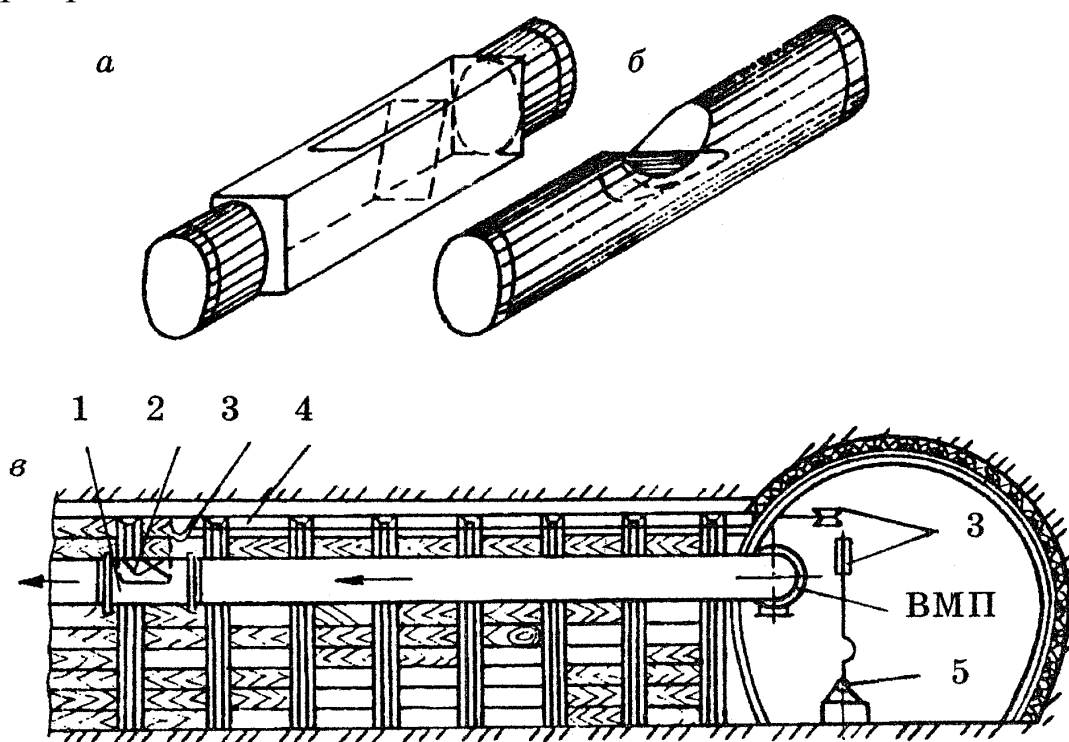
Устройство для разгазирования: а, б – схемы устройства; в – схема установки; 1 – патрубок; 2 – клапан; 3 – ролики; 4 – трос; 5 – ручная лебедка
